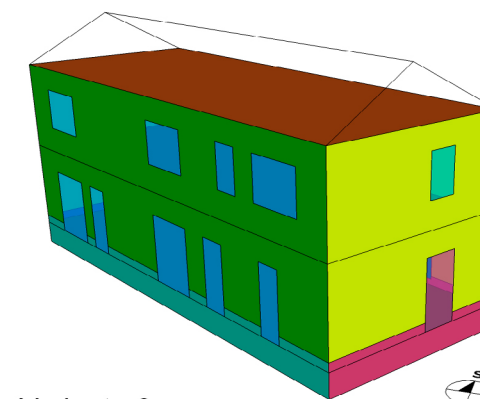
Varianta 4 Dutinové cihelné bloky 240 mm + MW 320 mm.
